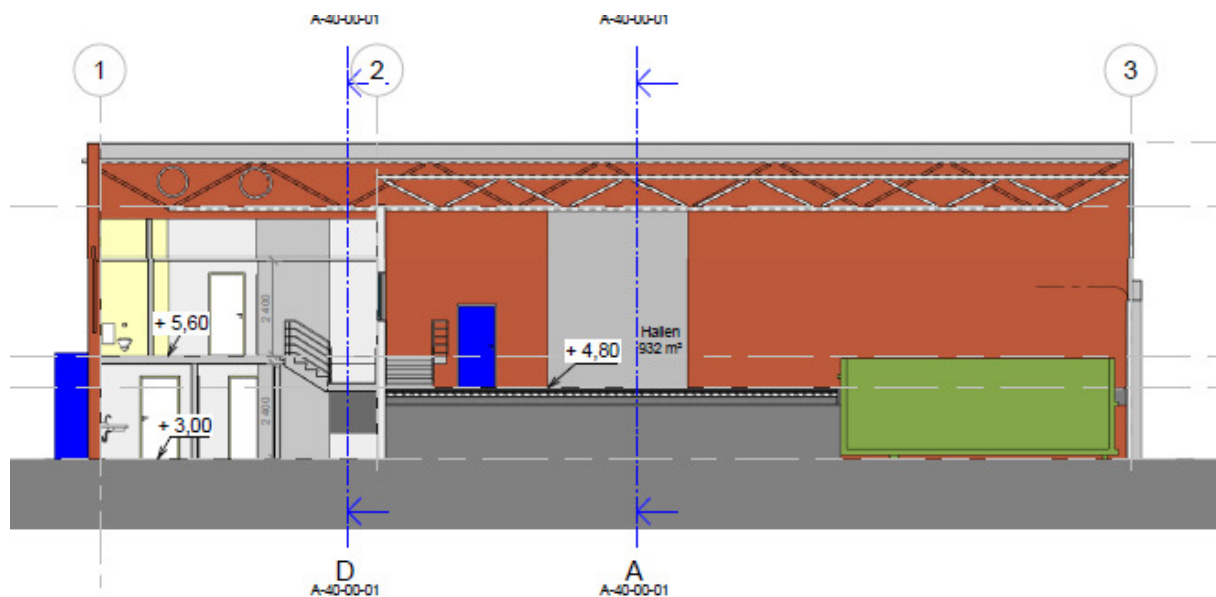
Oversiktsplan. Illustrasjon: Norconsult.
